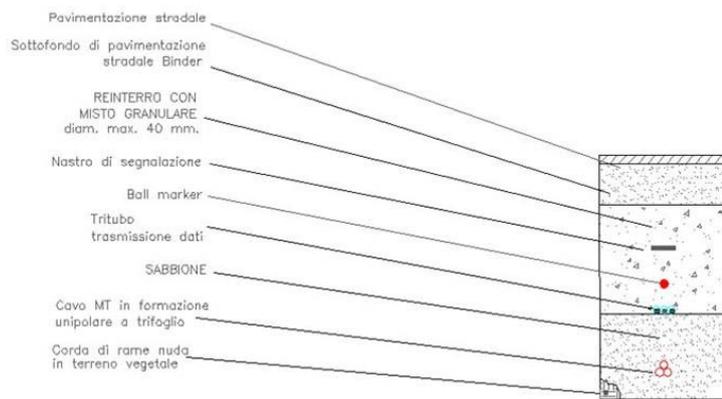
Particolare Posa del cavidotto all'interno del manufatto stradale
